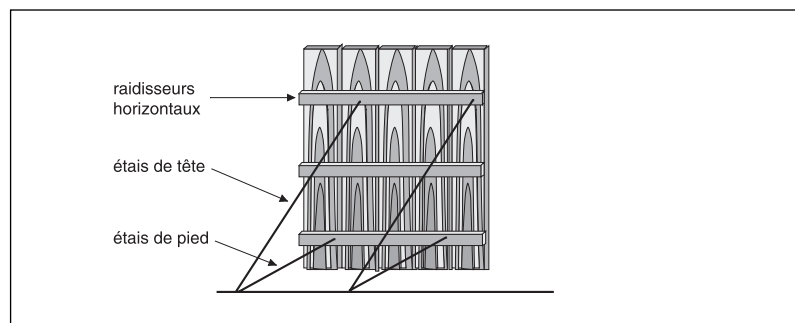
Coffrage en bois/étagage, raidisseurs verticaux et horizontaux pour éviter la déformation sous le poids du béton.
